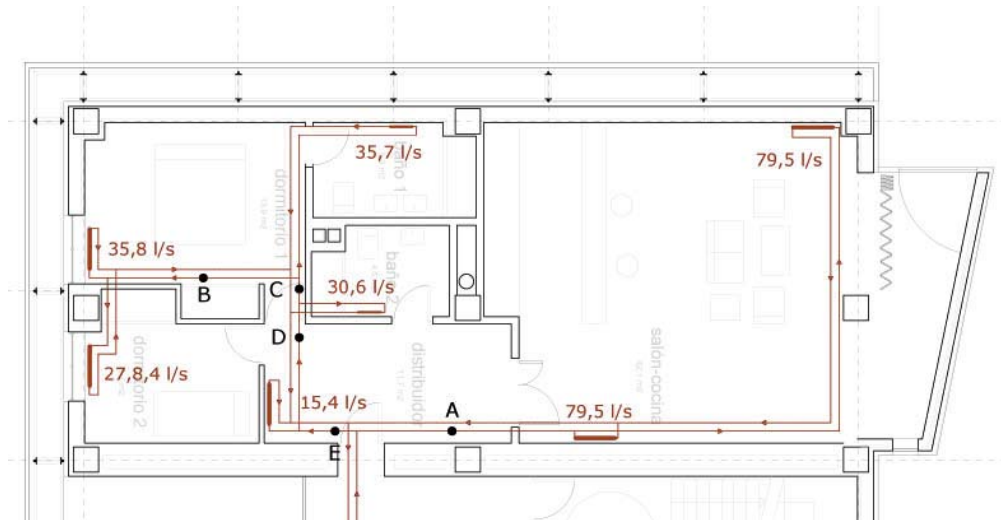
Esquema conductos calefacción vivienda tipo. Fuente: Elaboración propia
